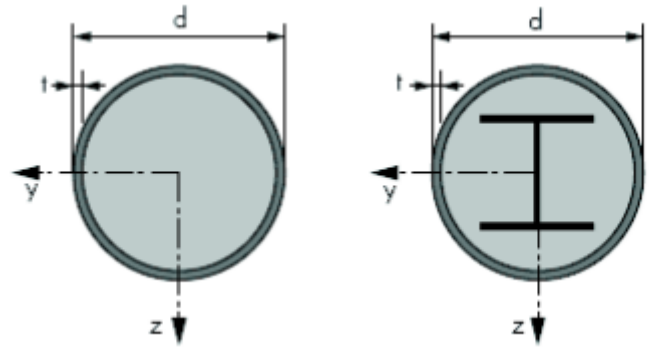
schéma d'un poteau métallique section circulaire avec profilé métallique enrobé de béton
